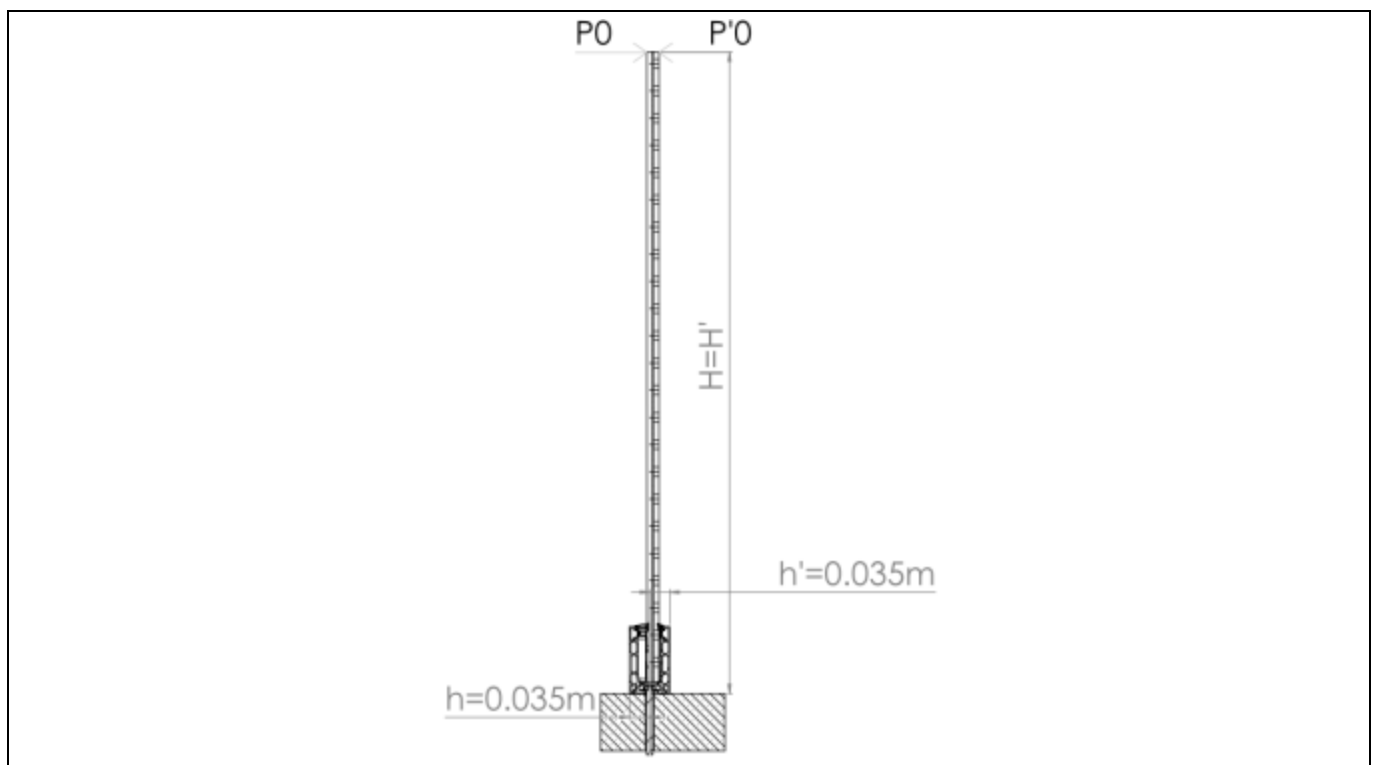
Fixation sur dalle du système garde-corps BV8900
